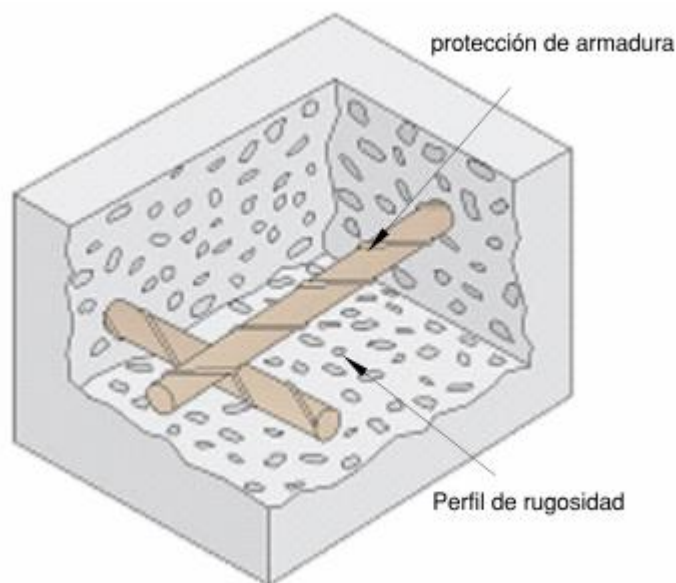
Corte de una Estructura donde se Aprecia Acero de Refuerzo y Concreto
